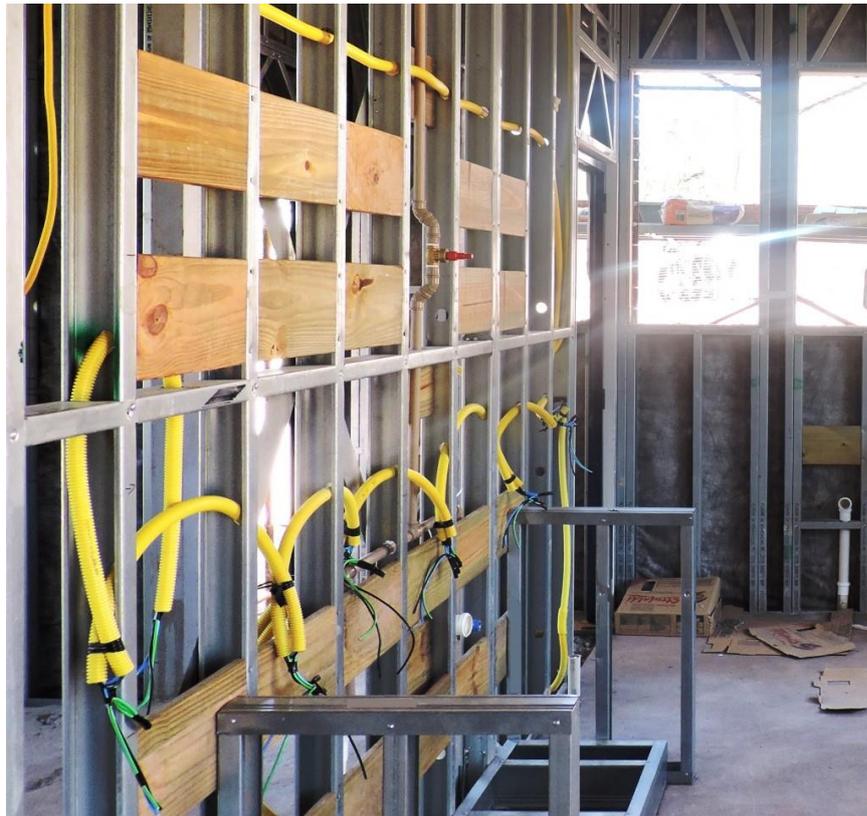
Instalação elétrica e hidráulica dentro do Drywall.
